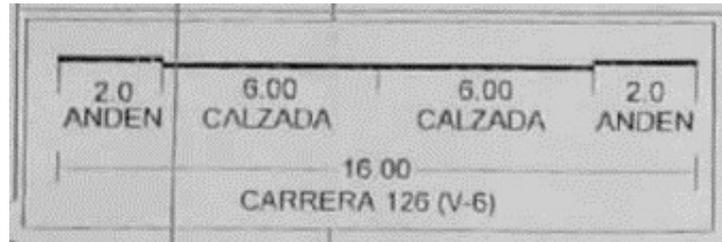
Perfil Vial – Tomado del plano urbanístico CU5F314/4-02
